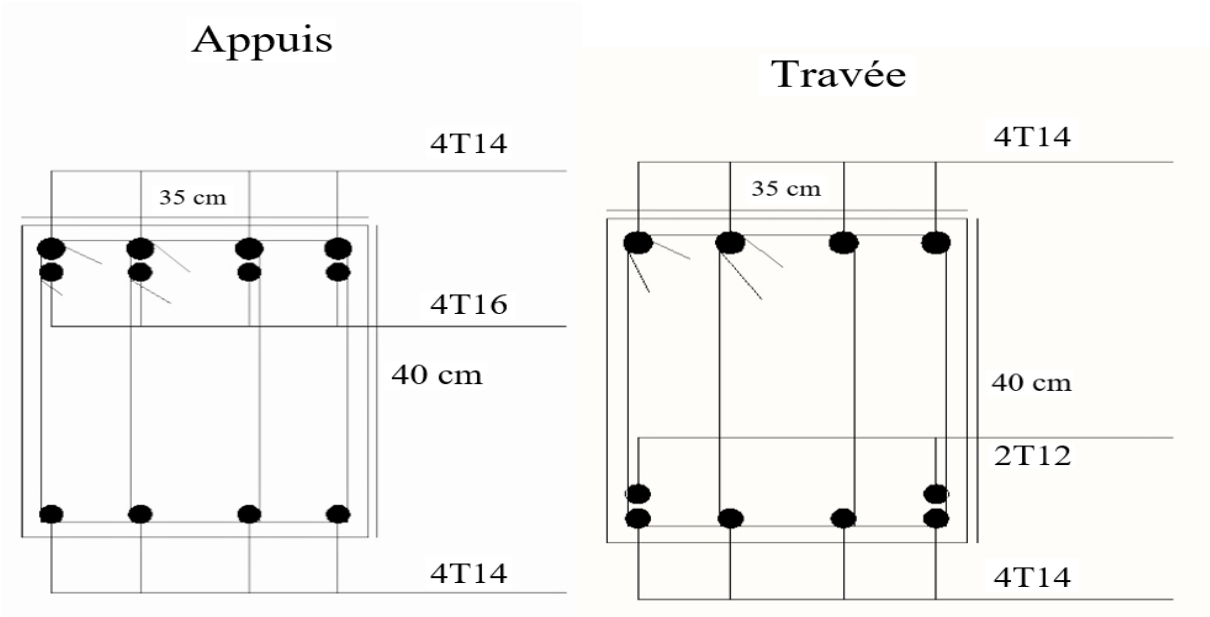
Schéma de ferrailage de la poutre principale (40 x 35) cm².
